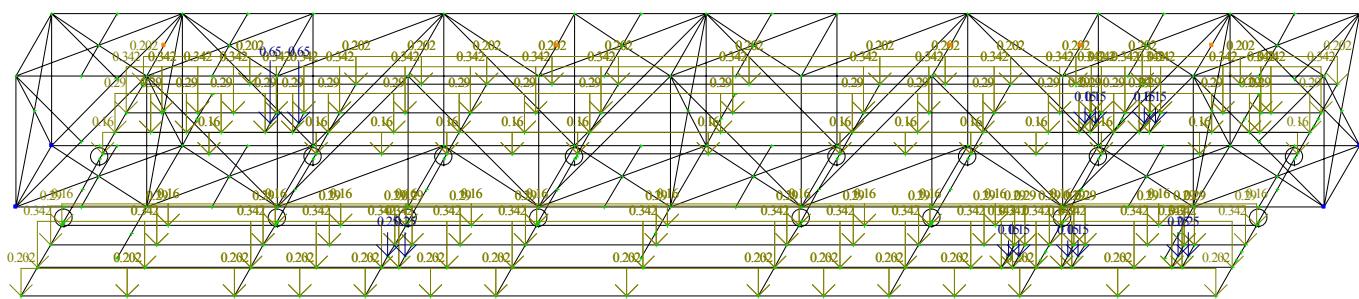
Вертикальные нагрузки от проектируемых трубопроводов и площадок
